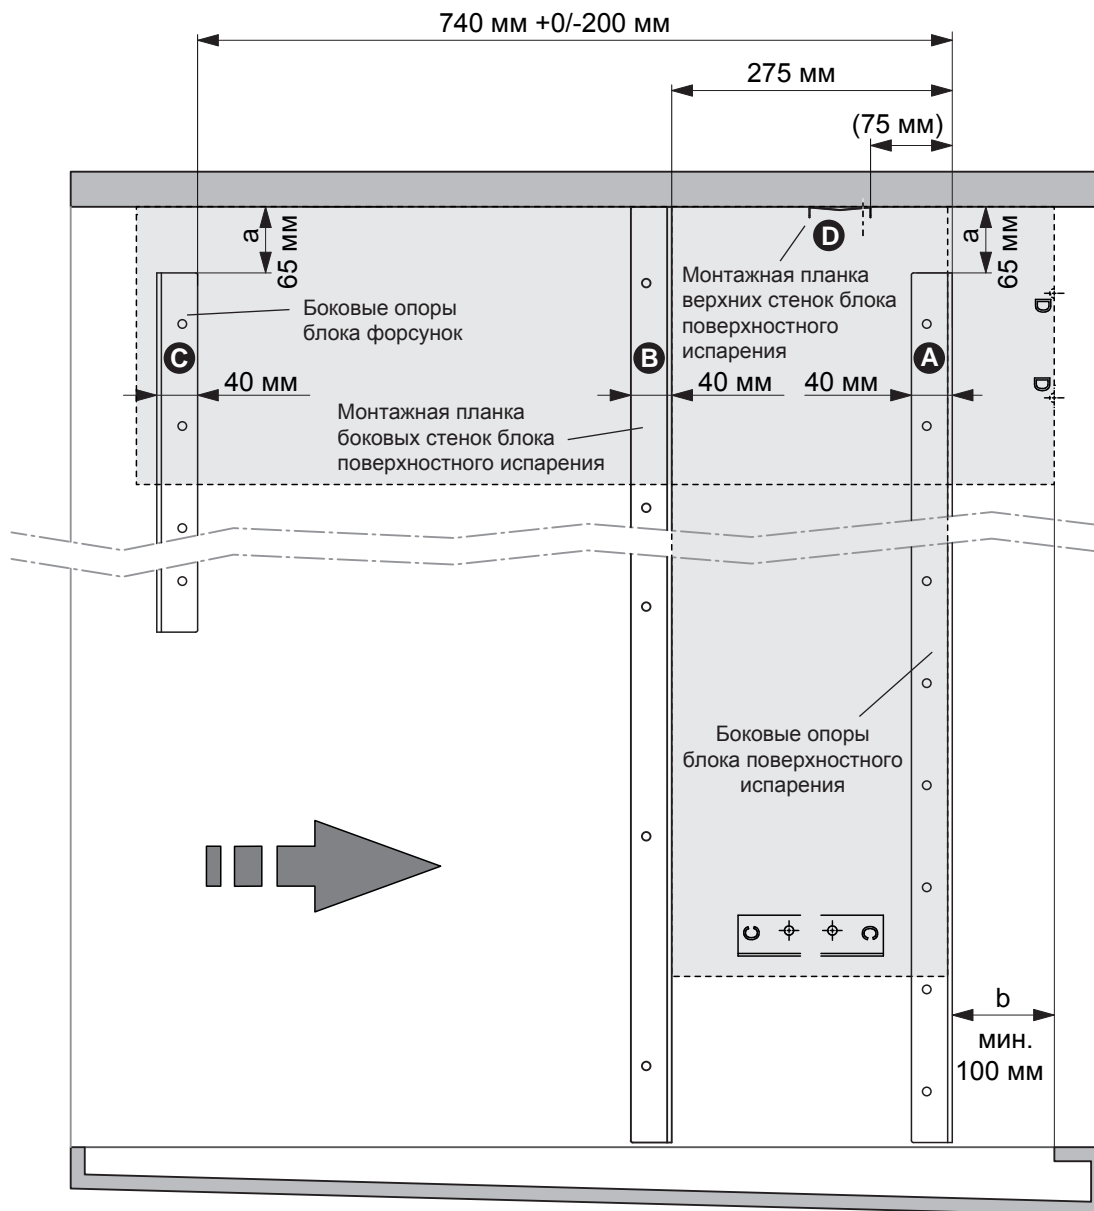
Разметка положения установки увлажнения (вид сбоку)
